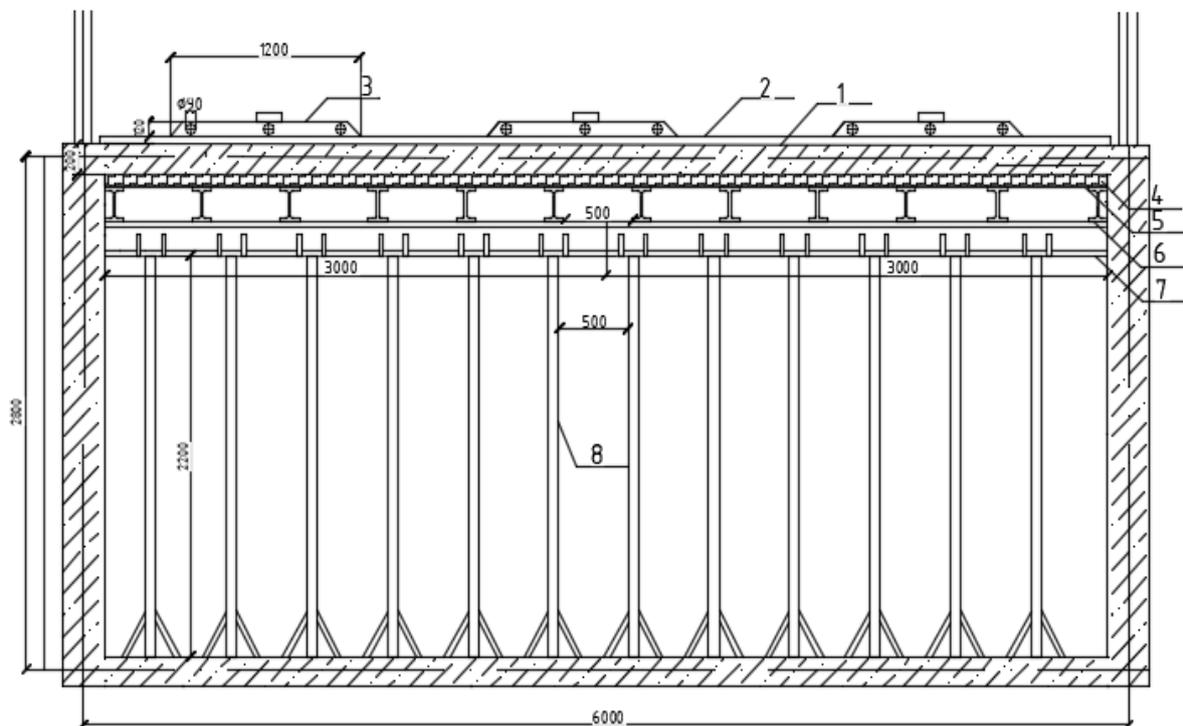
Схема теплообработки монолитных плит перекрытия:
